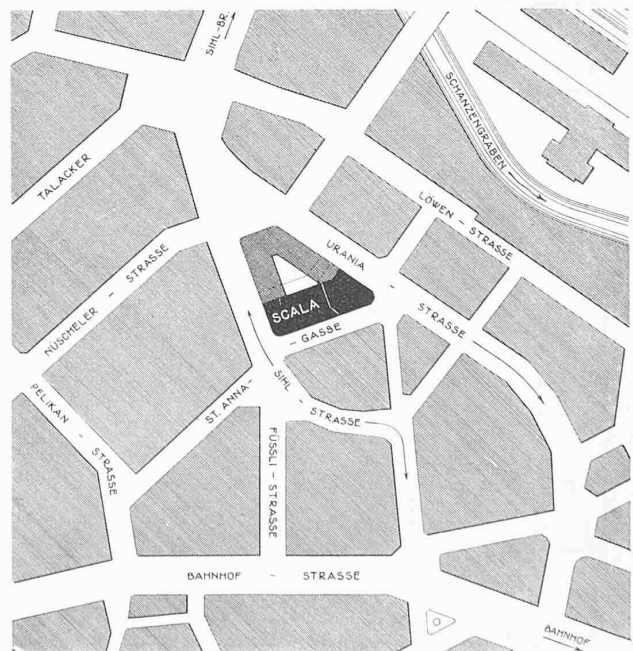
Lageplan des Scala-Baublocks. — Masstab 1 : 4000.
